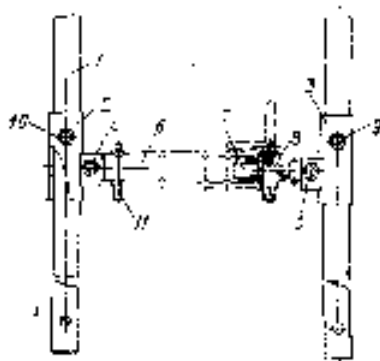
Рама инвентарного крепления ЦНИИОМТИ
